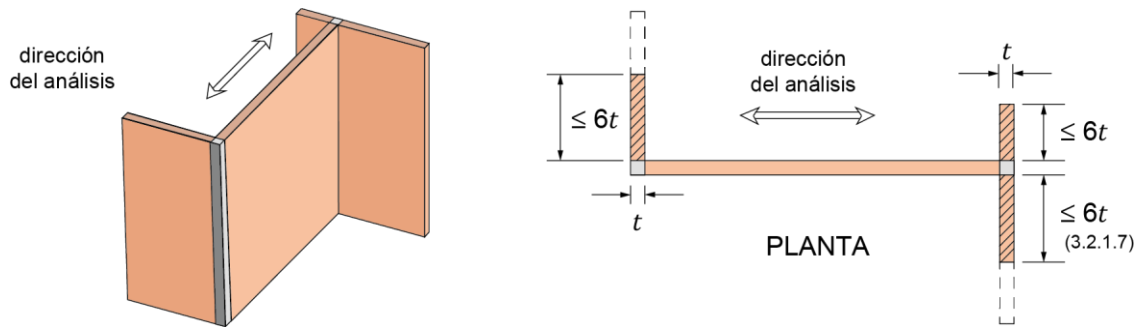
Ancho efectivo del patín a compresión en muros para análisis a base de marcos planos
